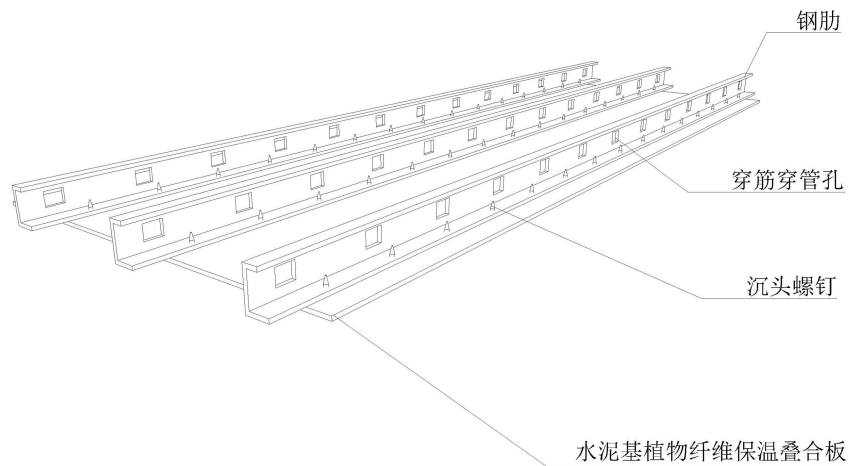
钢筋水泥基植物纤维保温叠合板示意图
